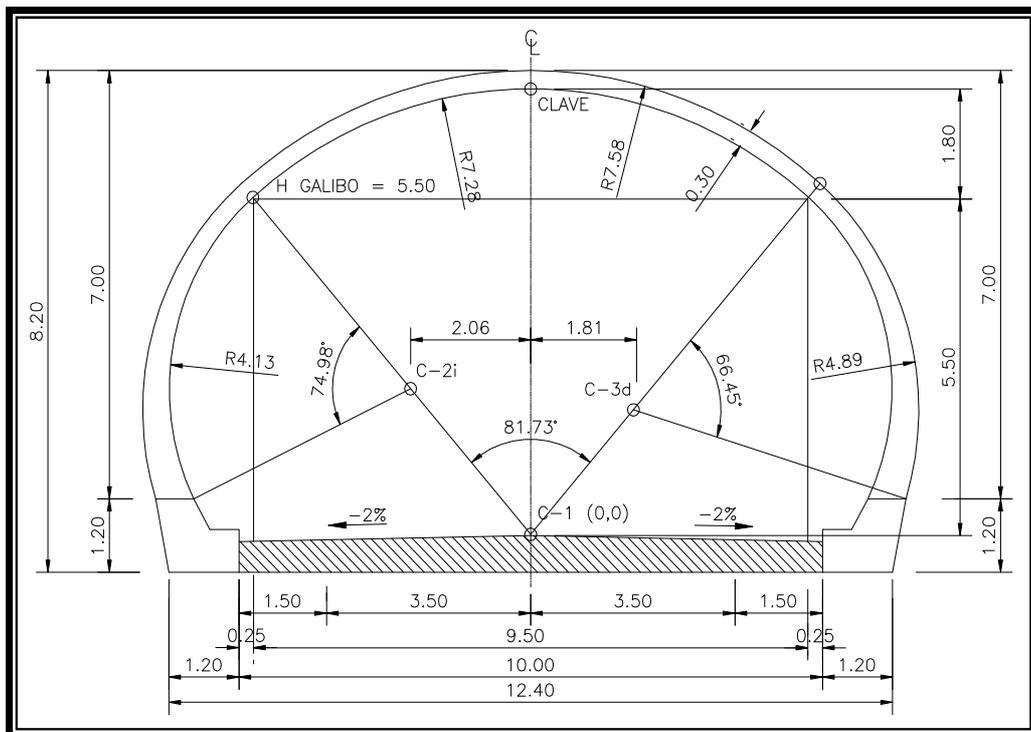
SECCIÓN TIPO PARA TÚNELES.
